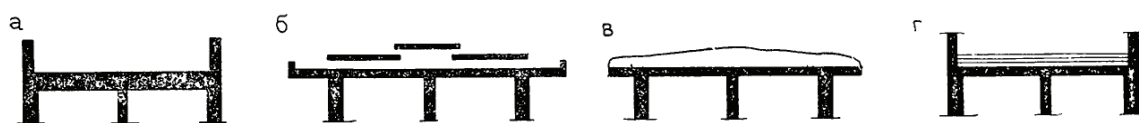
Покрытия зданий в сухом жарком климате: а – эксплуатируемая крыша, б – двойная крыша, в – крыша из грунта; г – крыша-ванна
